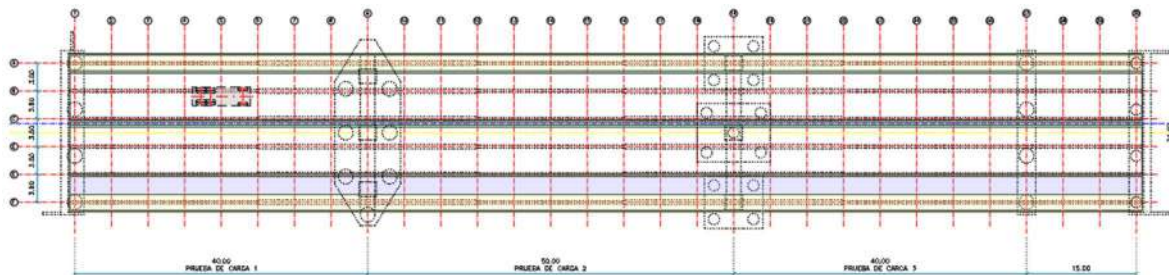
Posicionamiento de cargas, Prueba 1 – 1Camión (P1C1).
